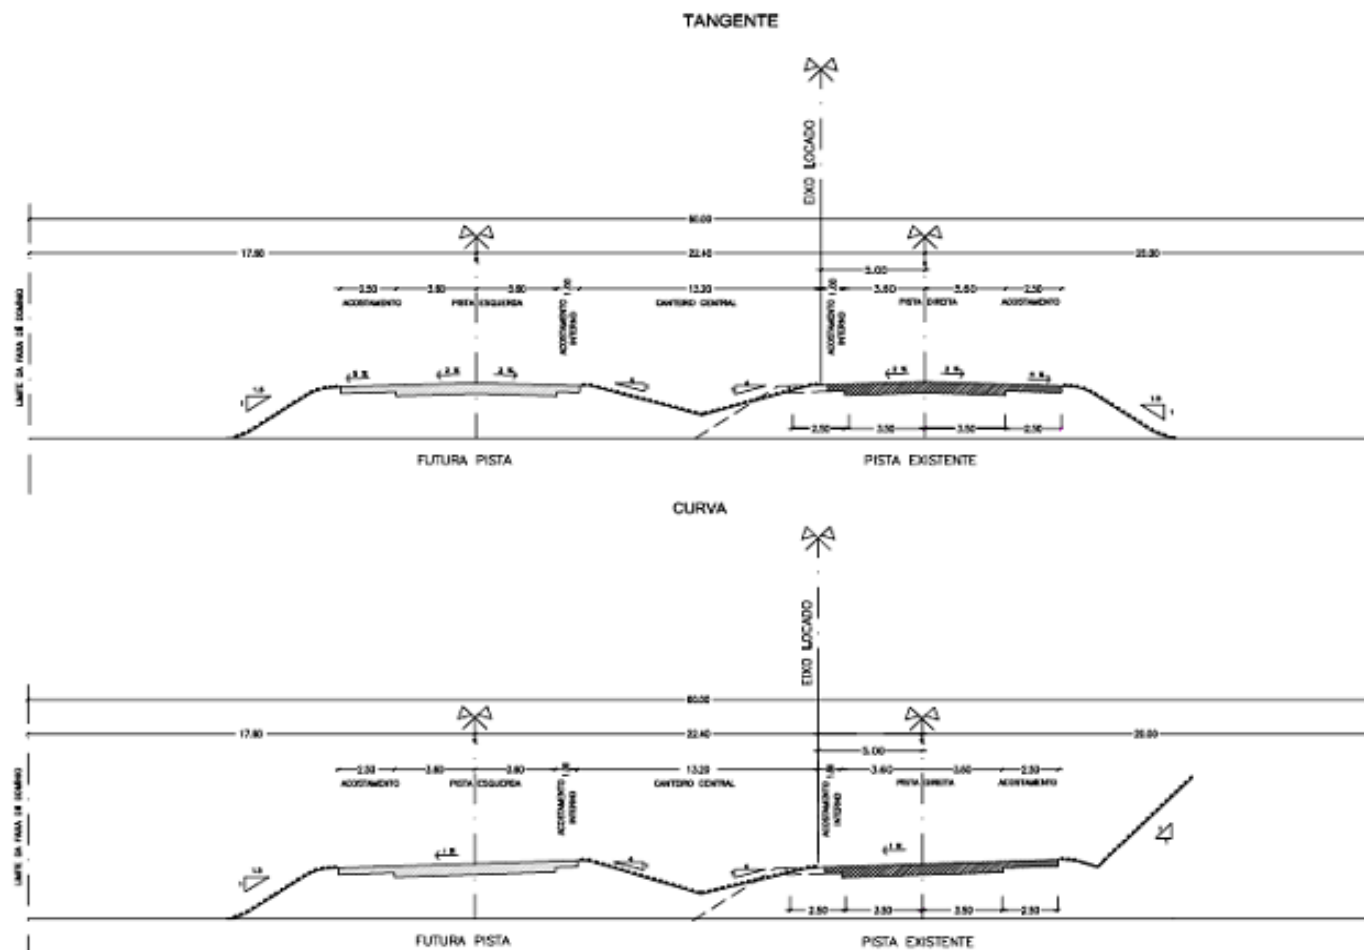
Segmentos com pistas separadas por canteiro amplo – Lote 3
